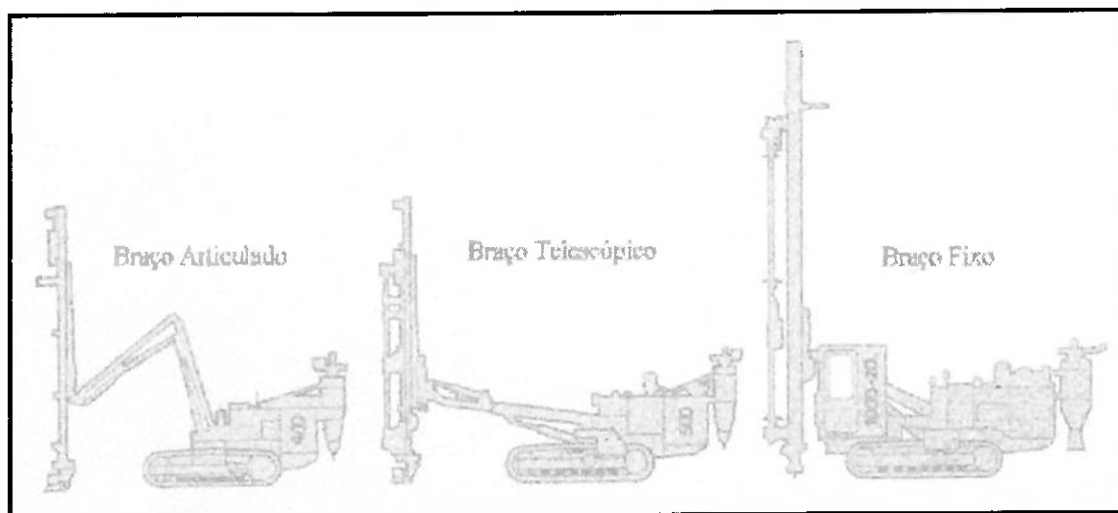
Tipos de braços para colunas de perfuração em bancadas
